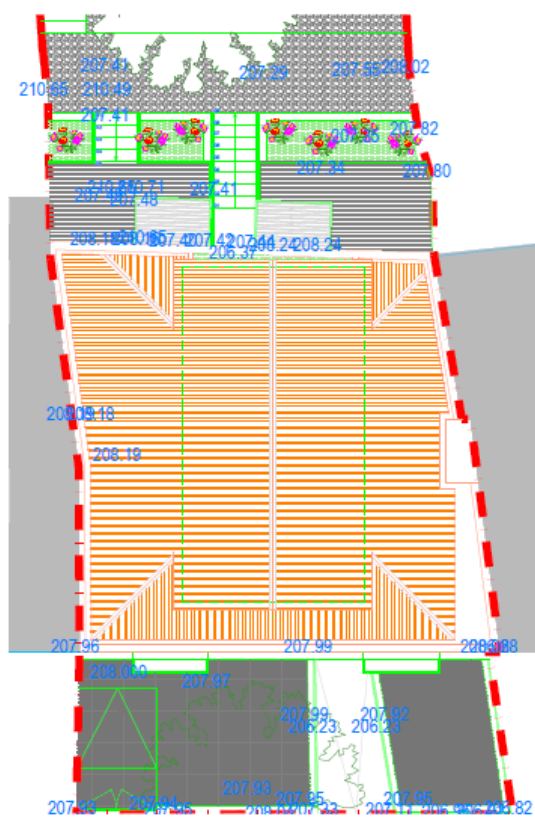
Planta de Cobertura (Arquitetude, 2017)
